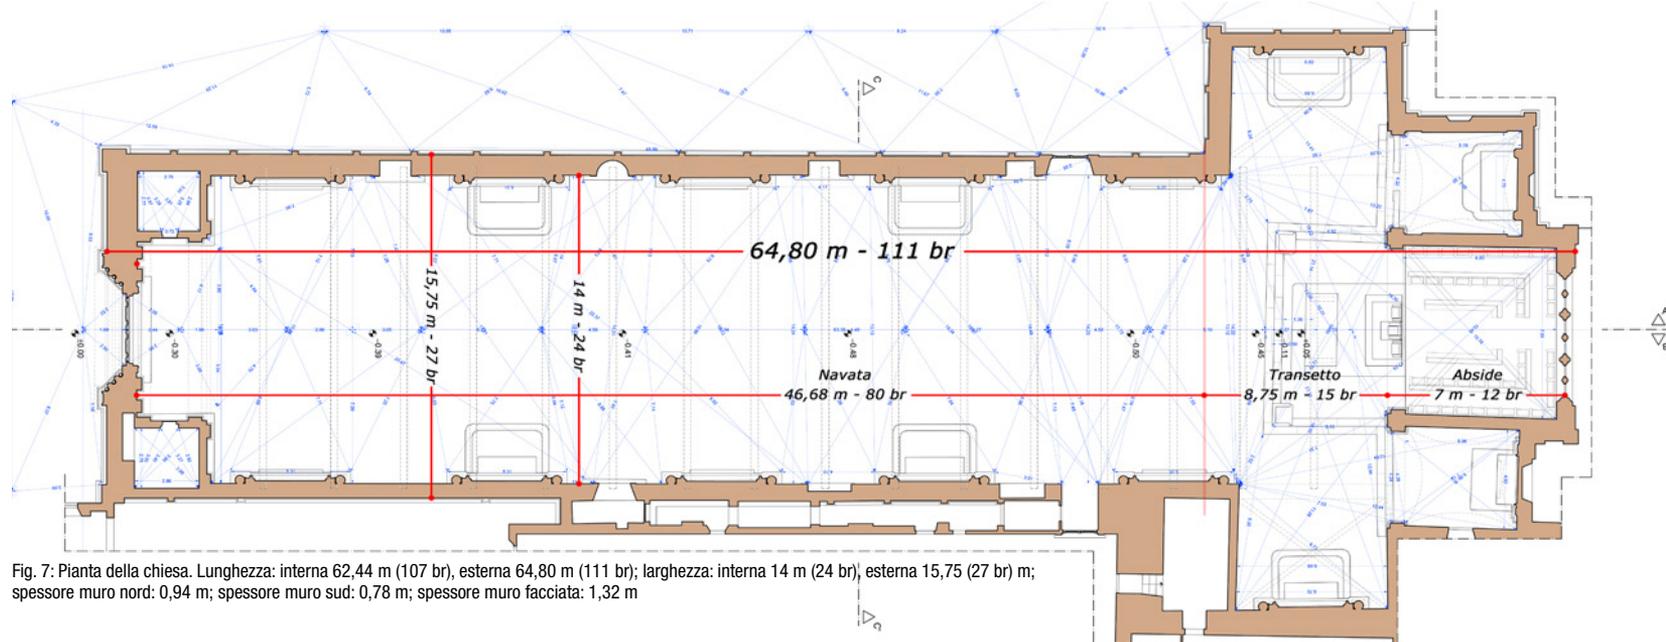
Pianta della chiesa. Lunghezza: interna 62,44 m (107 br), esterna 64,80 m (111 br); larghezza: interna 14 m (24 br), esterna 15,75 (27 br) m; spessore muro nord: 0,94 m; spessore muro sud: 0,78 m; spessore muro facciata: 1,32 m
